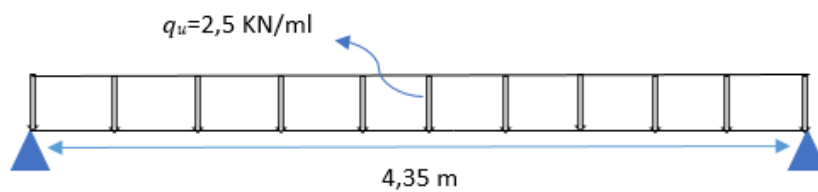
Schéma Statique de la poutrelle avant coulage du béton
